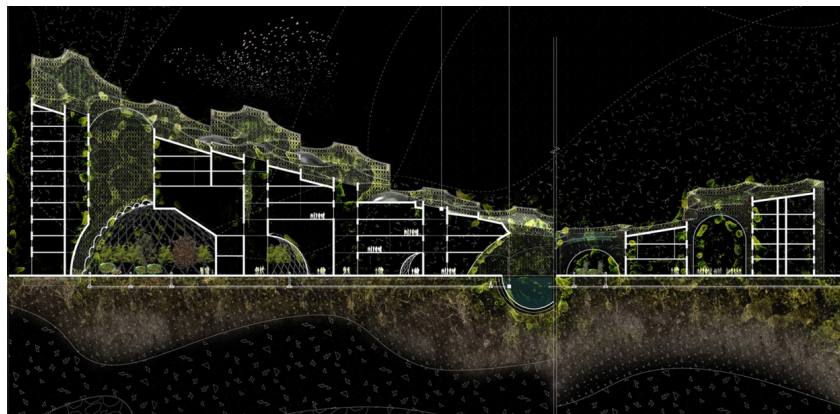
Biodiver[c]ity: detalle del proyecto sección.
